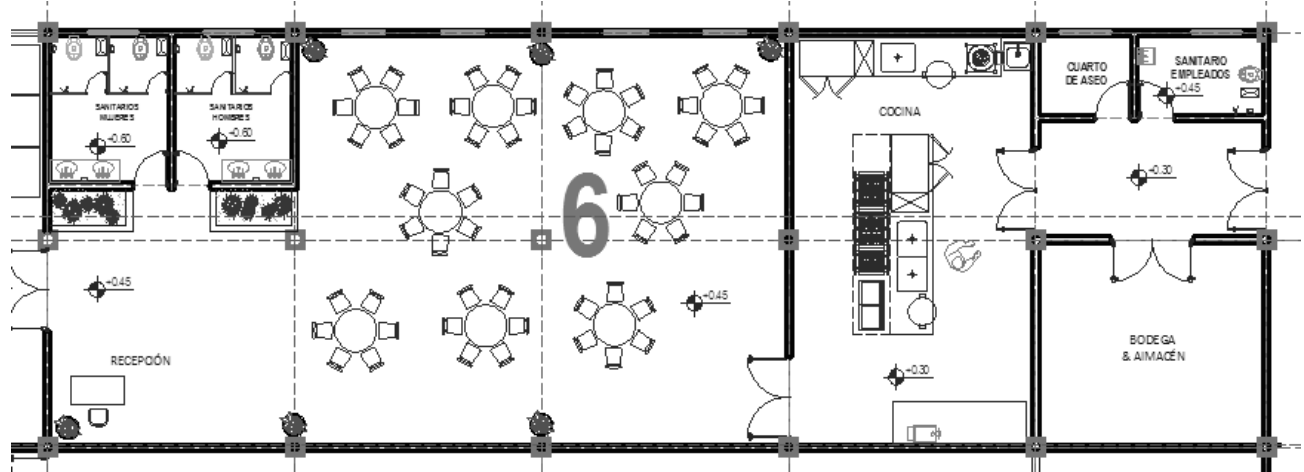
Planta esquemática del Restaurante. (Elaborada por el autor, 2015).
